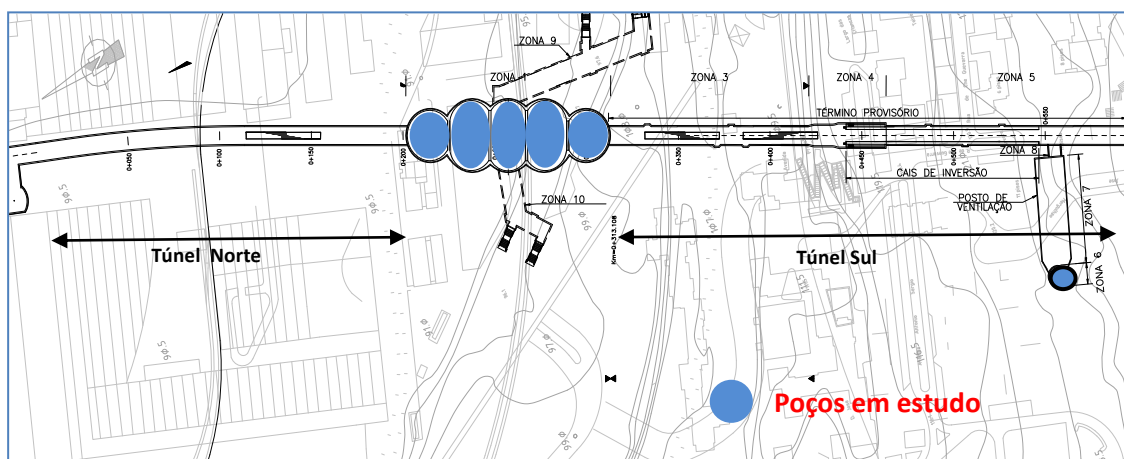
Planta geral da obra (adaptado NE, ACE).
